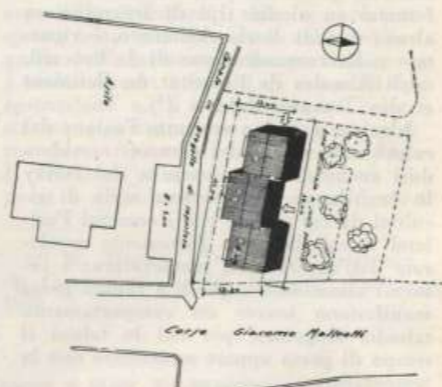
Planimetria: Motto "Nord-Sud B".
